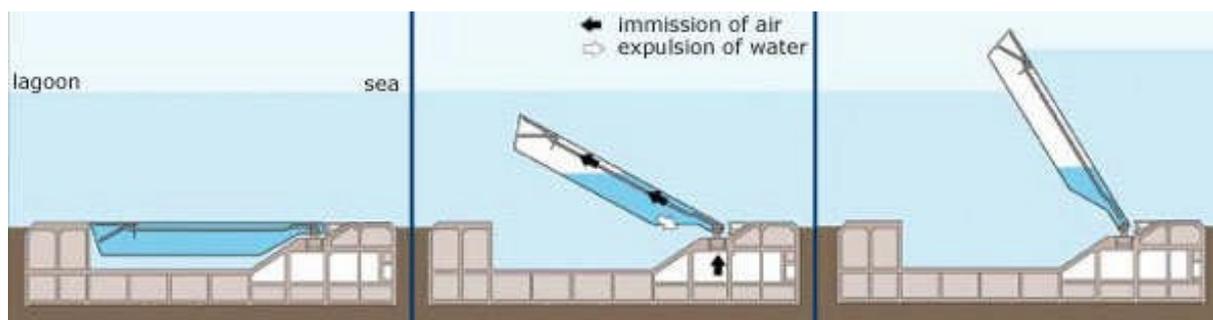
Dispositif MoSE : plan de coupe. (Lo Storto)
